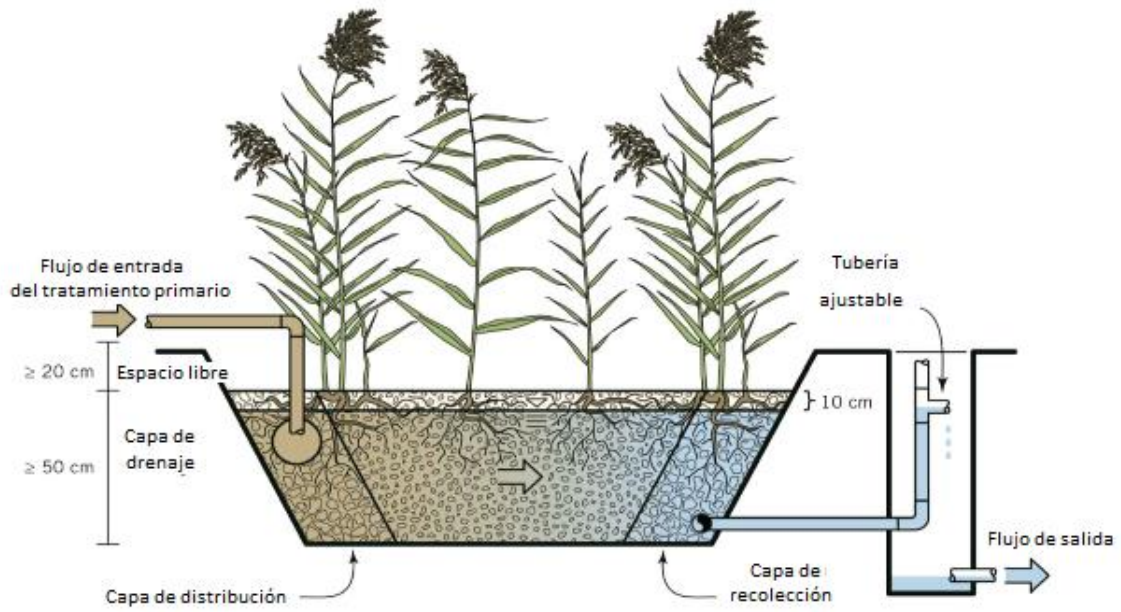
Imagen que muestra las cotas obligatorias estandar y detalles del humedal (no a escala). Fuente: IWA
